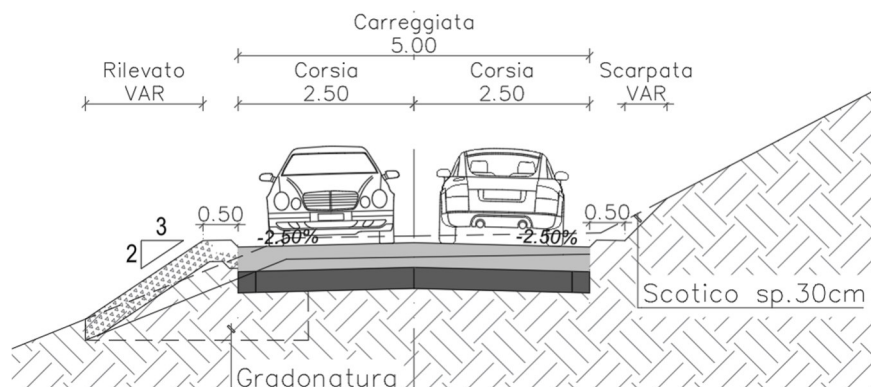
Sezione trasversale del tracciato secondario in sponda destra idraulica
